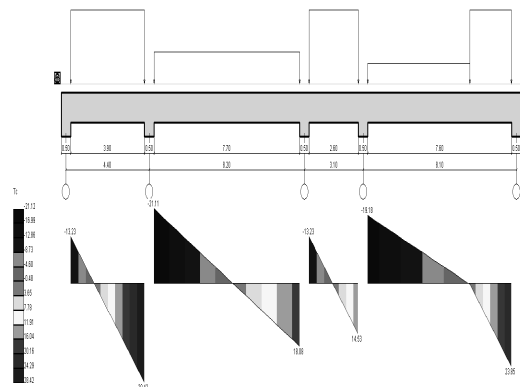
Епюра поперечних сил в залізобетонній балці до реконструкції
